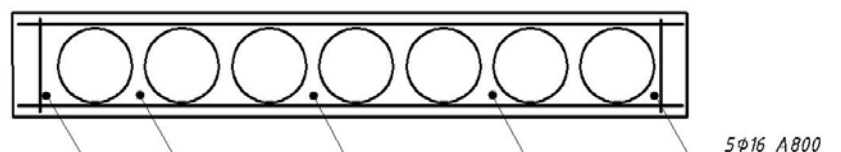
Схема армирования продольной рабочей арматуры
